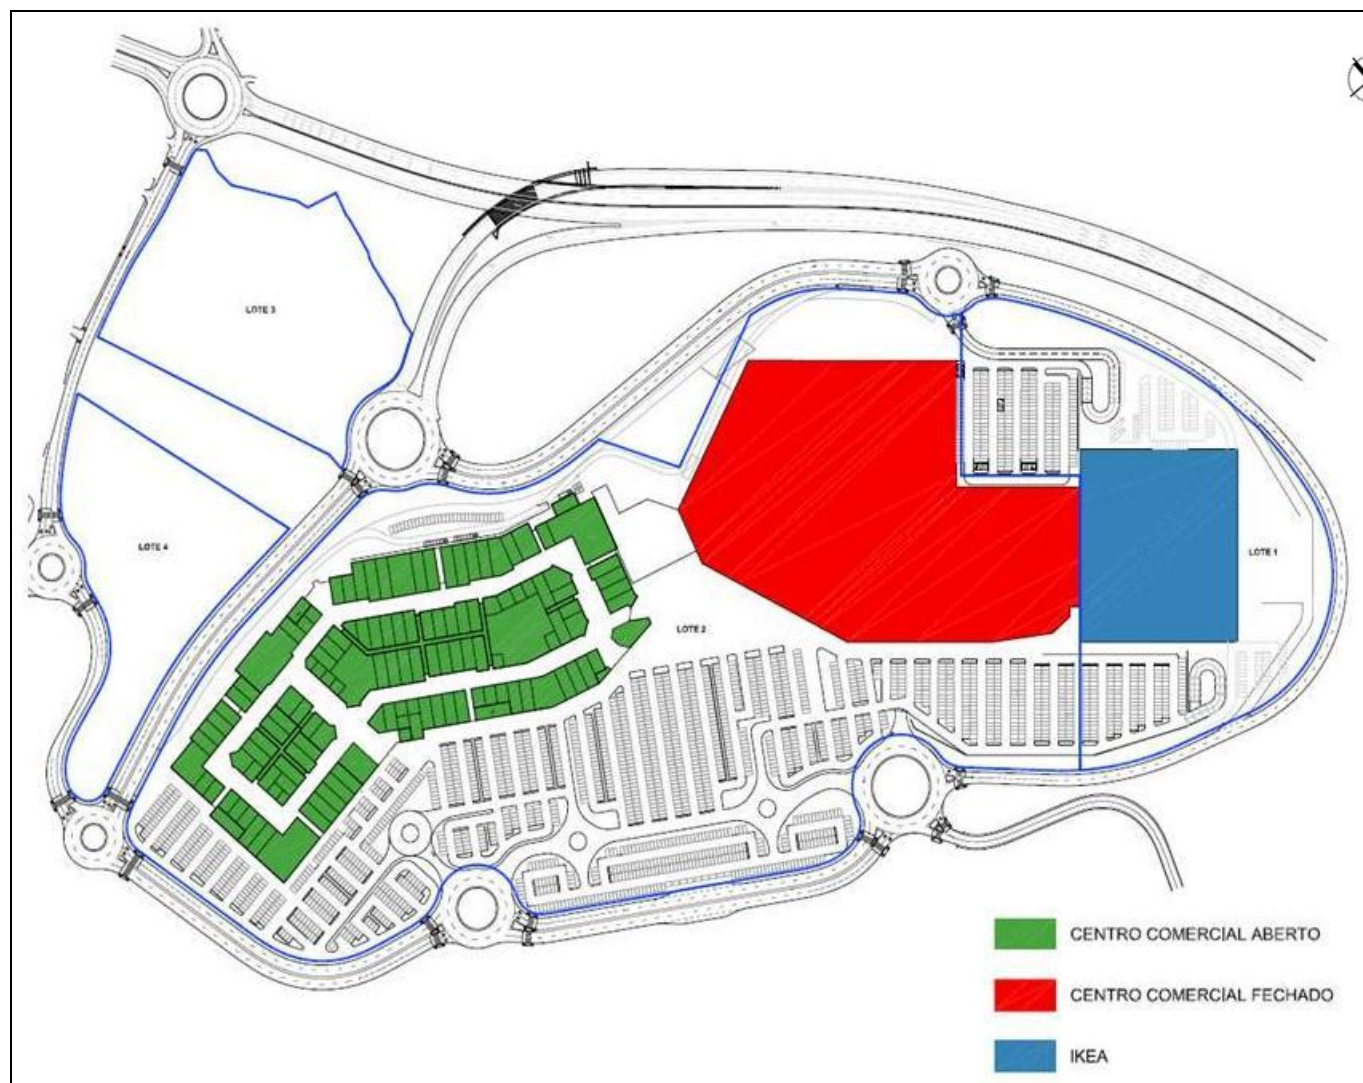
Ocupação prevista para os lotes 1 e 2 aquando da elaboração do EIA
